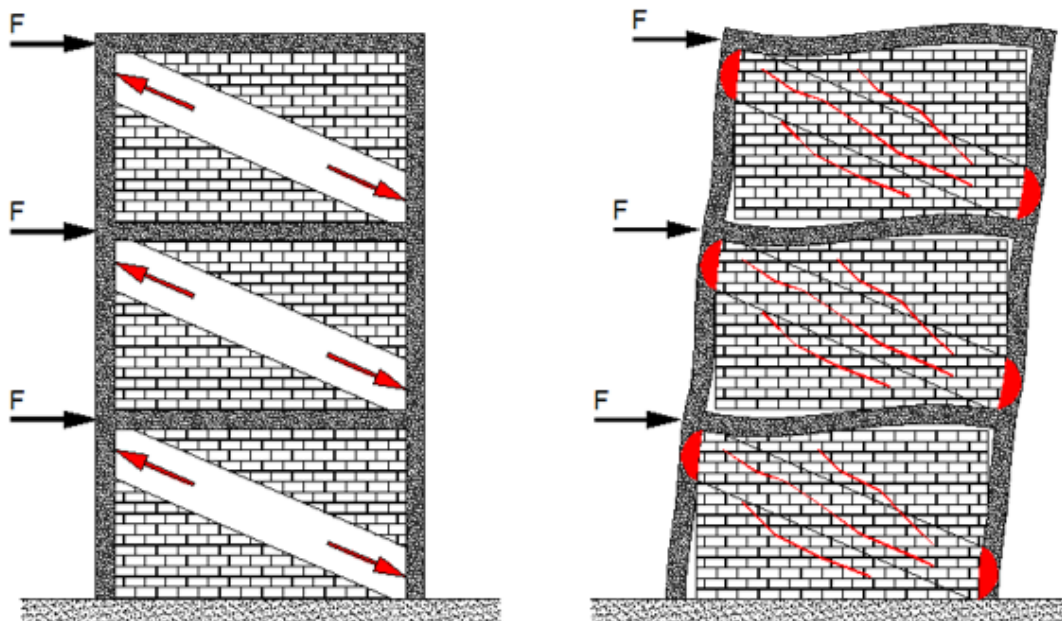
Aparición de bielas diagonales en la tabiquería y daños en pilares y tabiquería.
